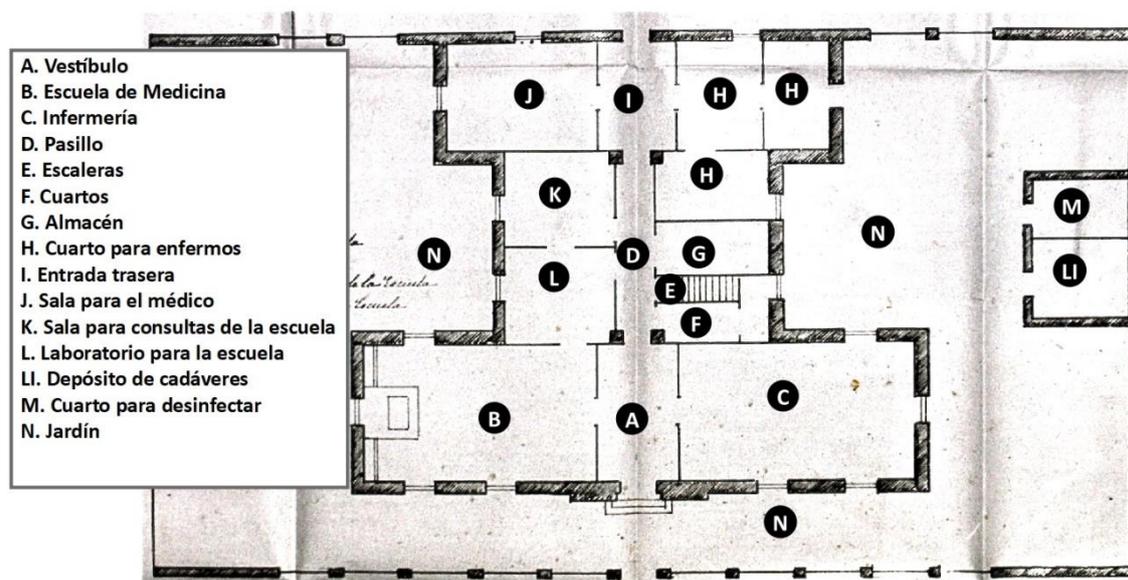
Planta baja del hospital español (ADT, Proyecto de Antonio Alcayne, 9 de febrero 1887)
